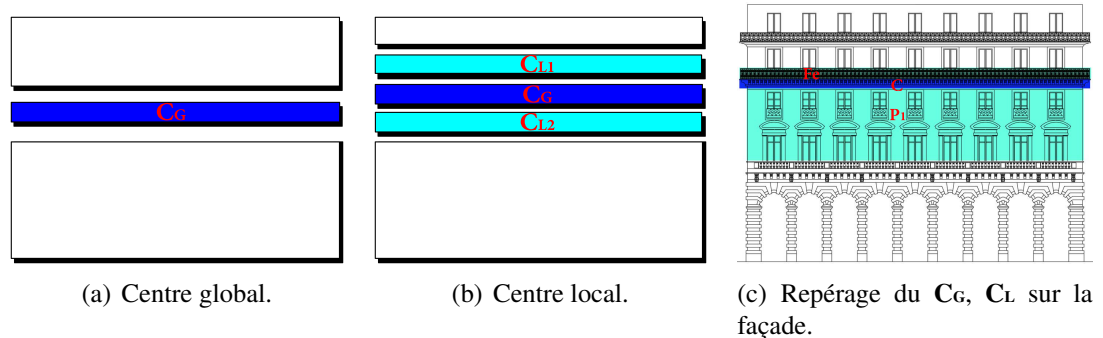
Schémas de structuration de la façade (Banque d'Algérie).
